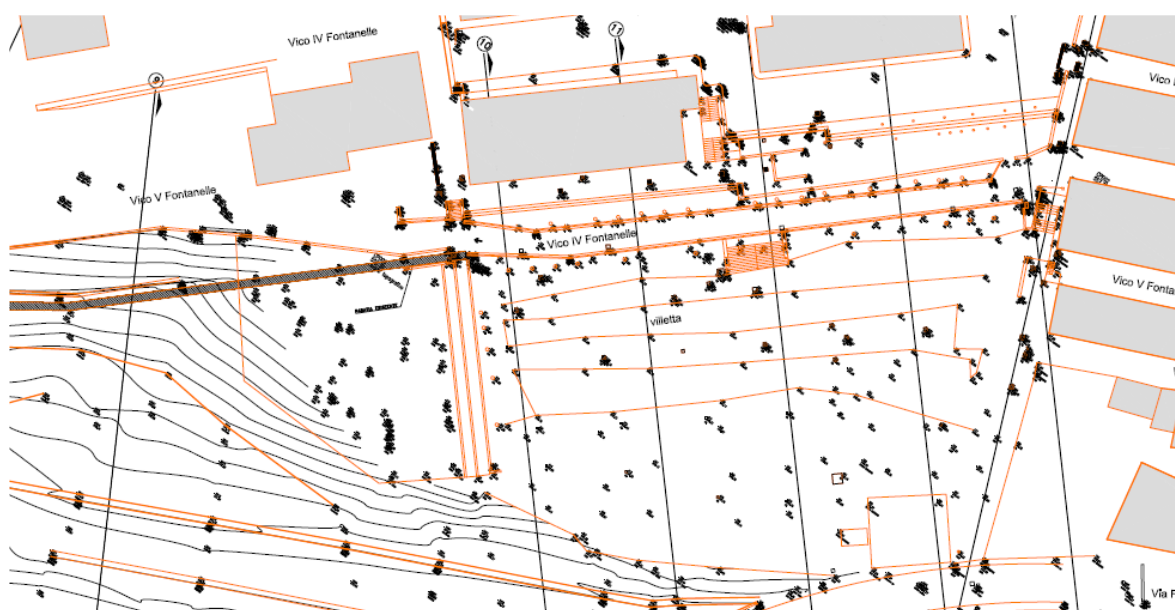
Via Fontanelle – Planimetria ante-operam
